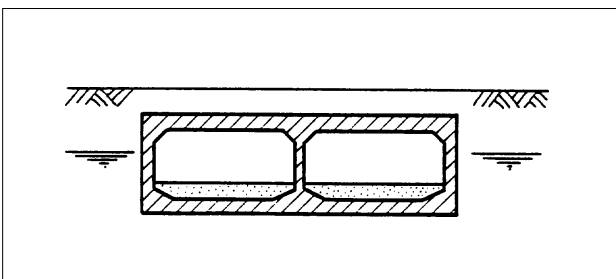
Im Tagbau erstellte Tunnels für den Strassen- und Eisenbahnverkehr:
